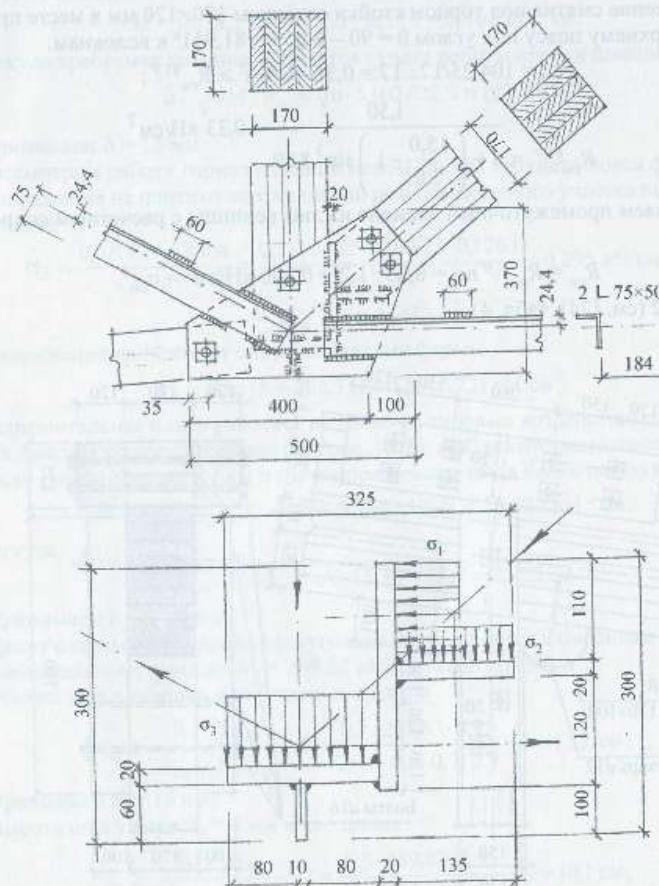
Промежуточный узел *E* нижнего пояса
